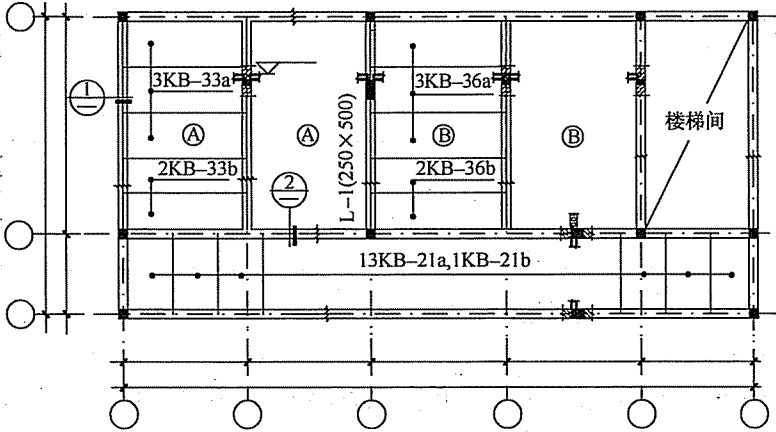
用正投影法绘制预制楼板结构平面图
